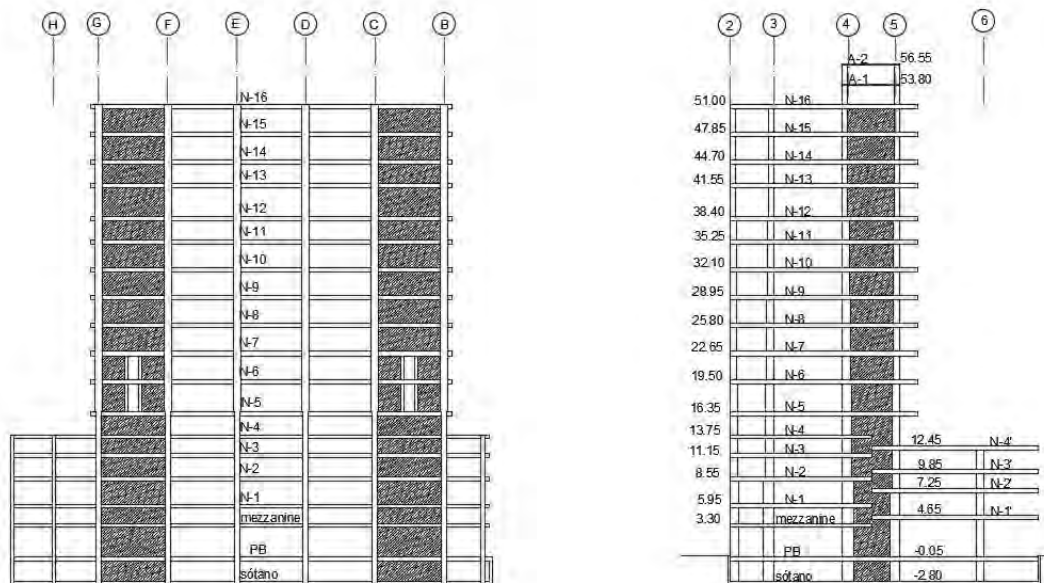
Vistas en elevación de las fachadas norte y este del edificio
